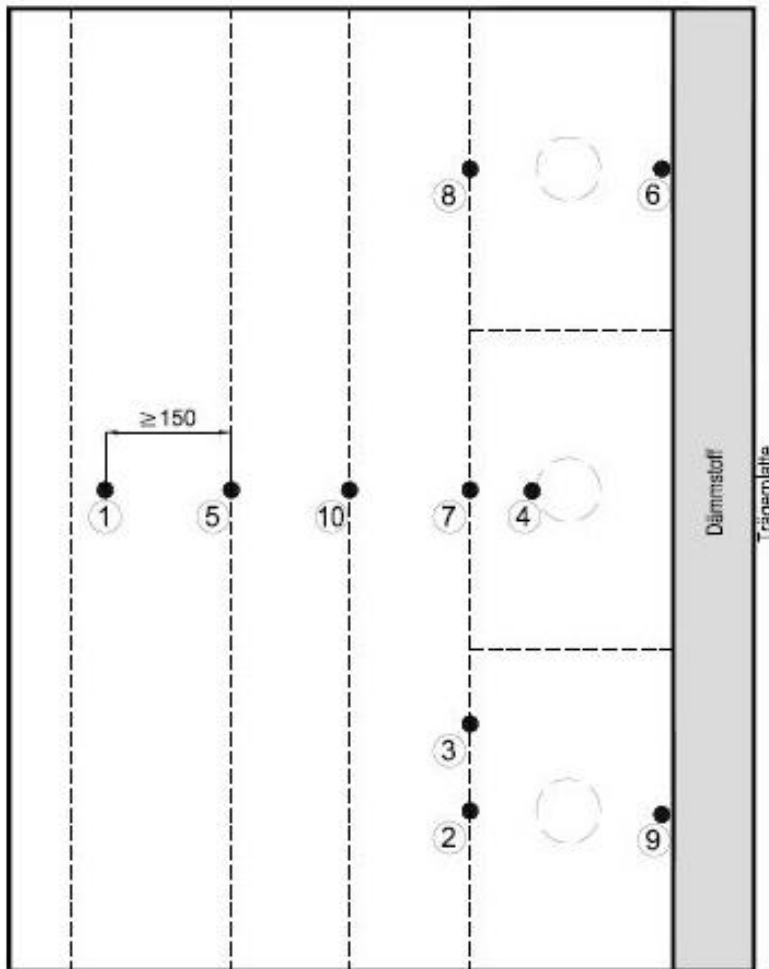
Draufsicht der Beschussorte beim Probekörper Flachdach
